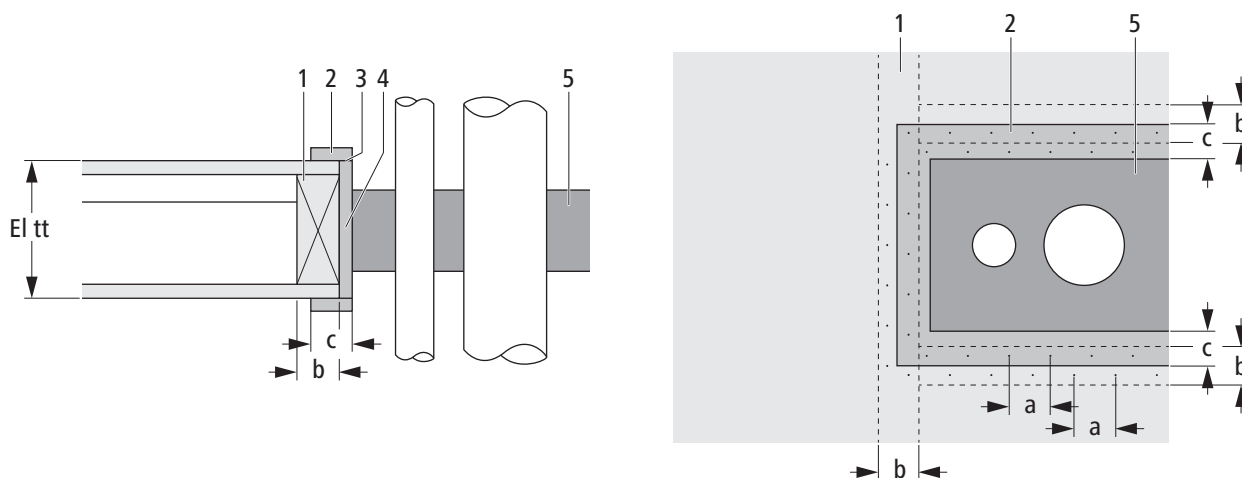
Installazione Optivis-Tec in costruzione in legno con colpetto RF1
